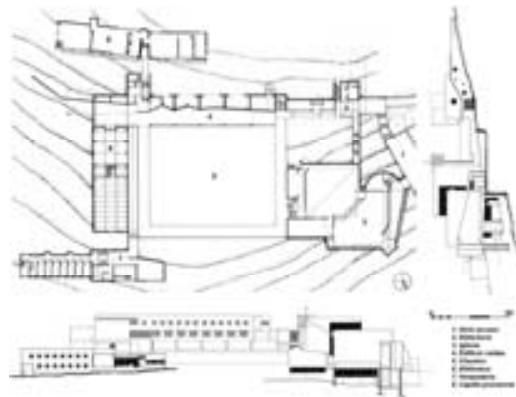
Planos de conjunto monasterio Las Condes (Gross y Vial, 1988).
